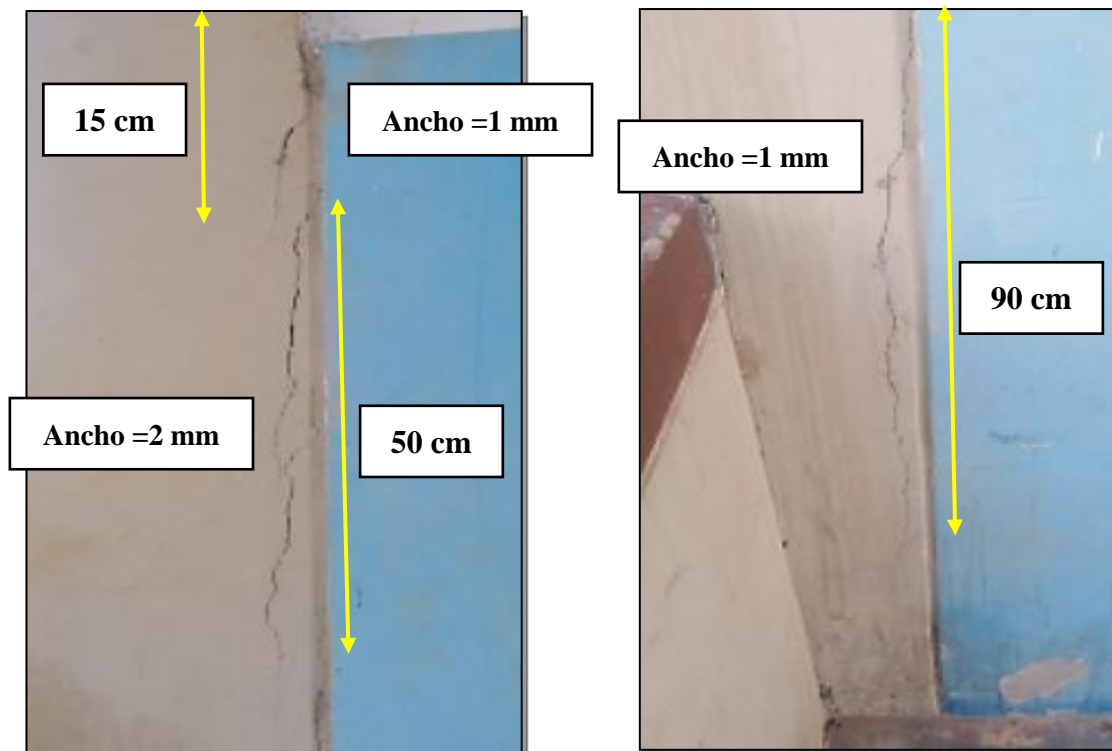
Fisuramiento de las columnas– Segundo Nivel
